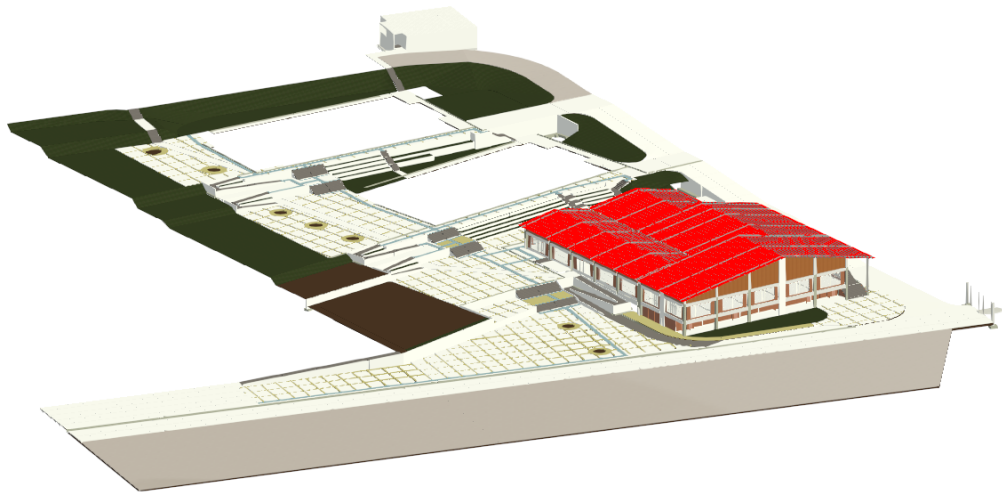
Proyecto ejecutado por el Consorcio I, incluye las Obras Exteriores y el Comedor.
